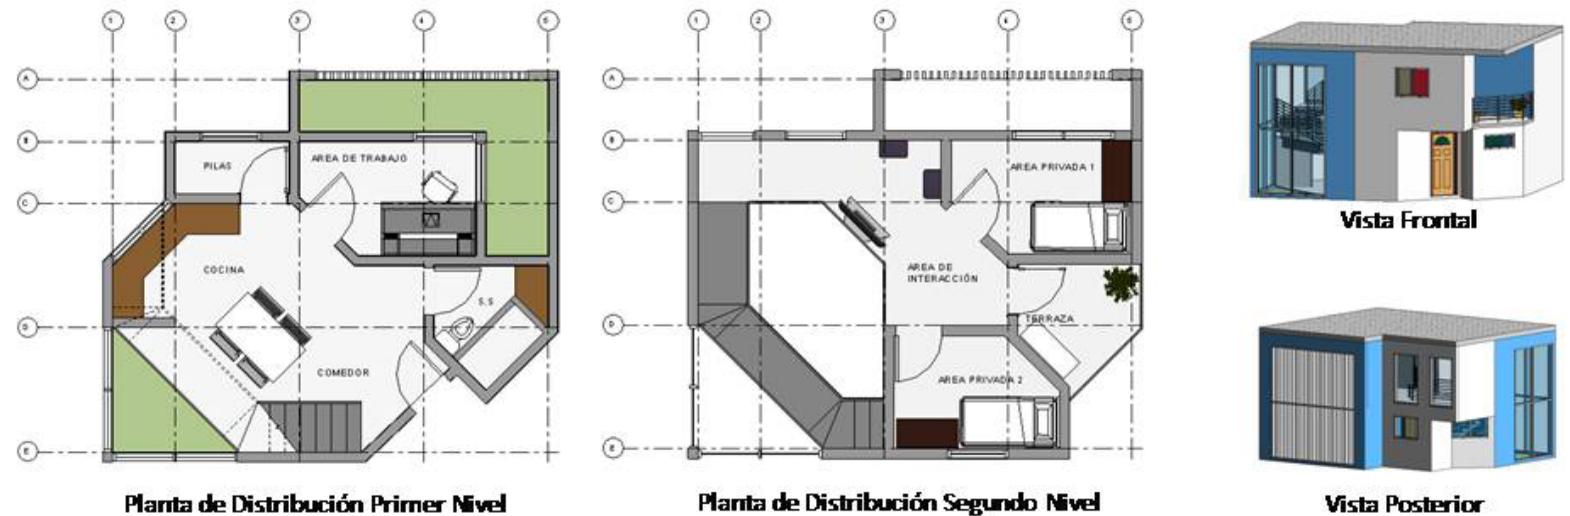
Plantas de distribución Módulo Base + 1 Espacio Privado y Espacio de Trabajo
